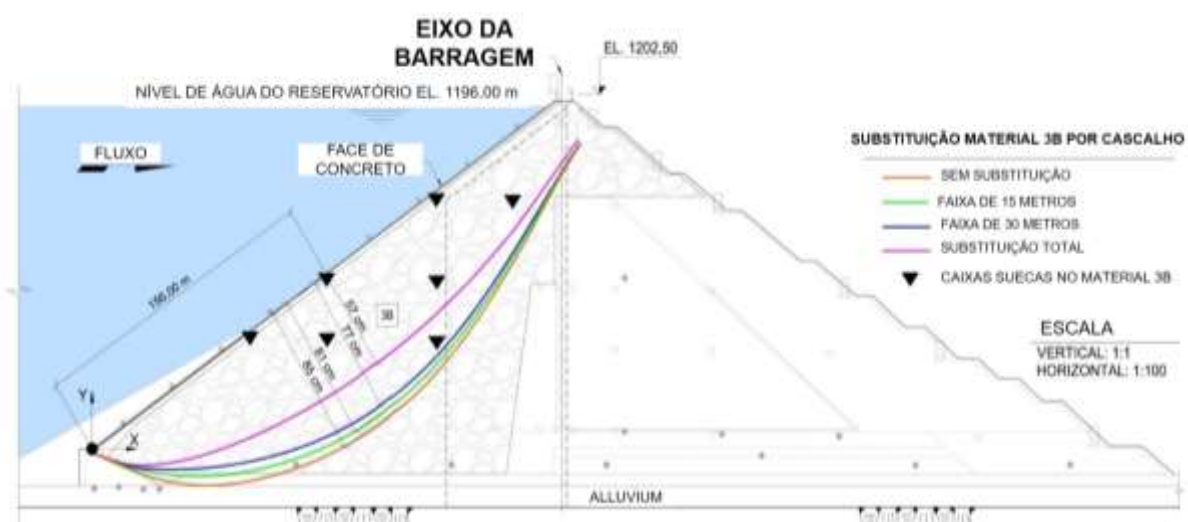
Deslocamentos da Laje Modelo 2d – Na Seção Típica de Projeto
